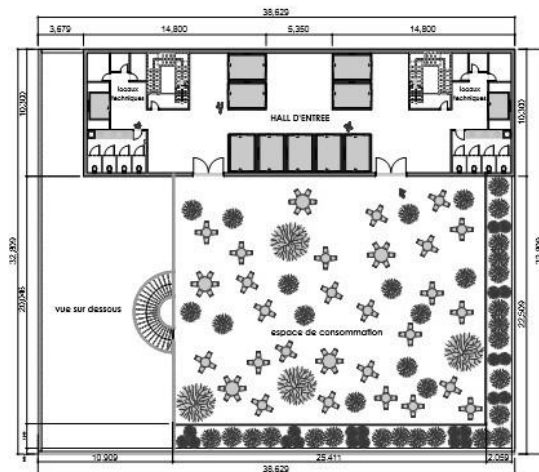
plan de 2e niveau de restaurant ((niveau 18))
